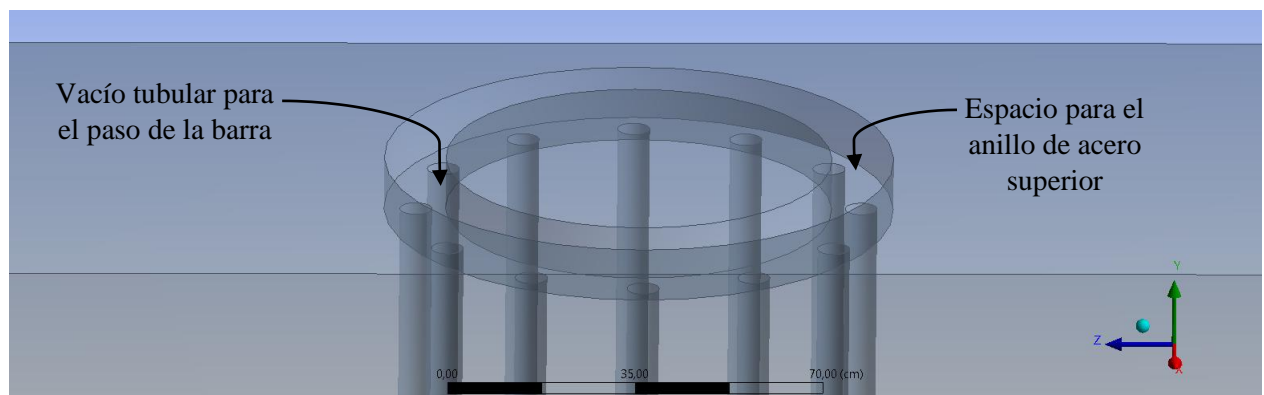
Detalle de la zona superior de la viga de hormigón armado.
